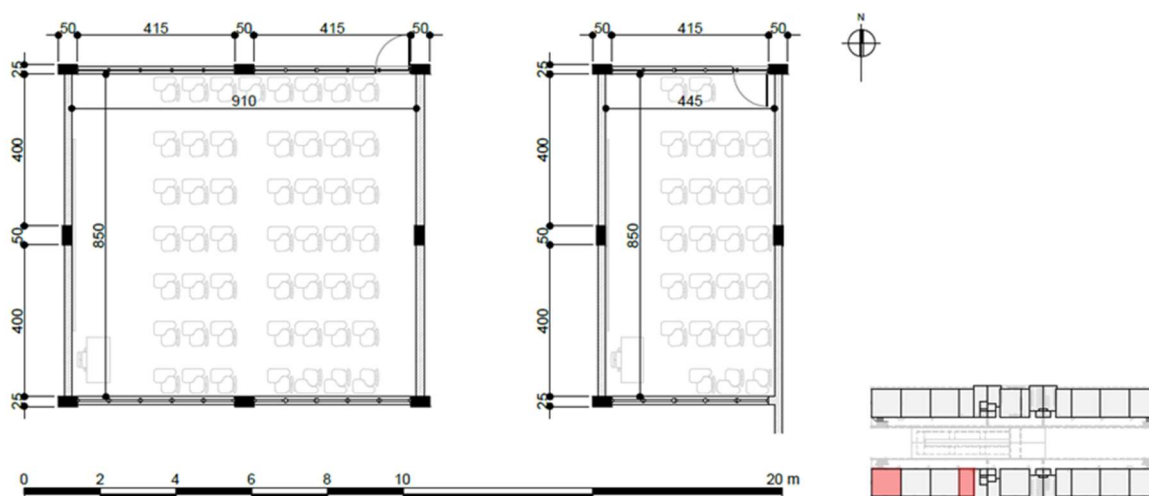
Planta Baixa do Pavimento Superior - Edifício Multiuso
